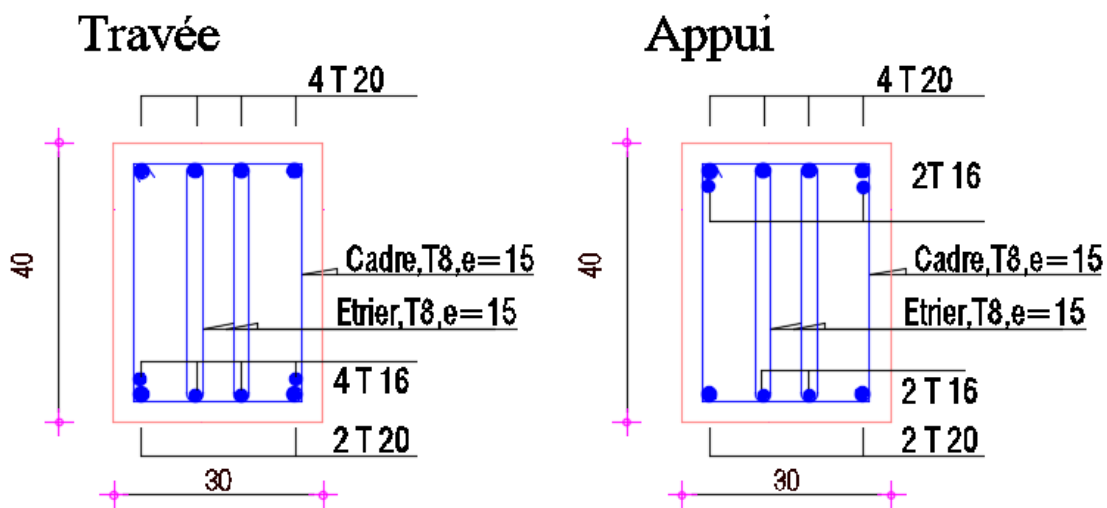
Ferrailage des poutre secondaire terrasse
